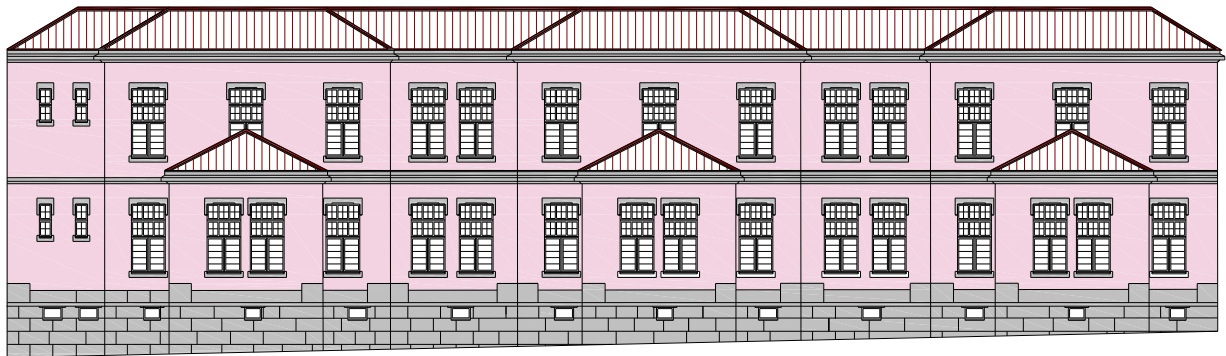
Fachada lateral Poente (orientada a Sudoeste) [Fonte: Autora]
